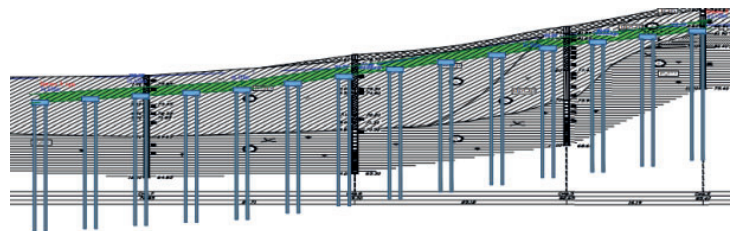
Вертикальная привязка буринъекционных свай ЭРТ и монолитных железобетонных ростверков под напорный трубопровод $d=1020$ мм
